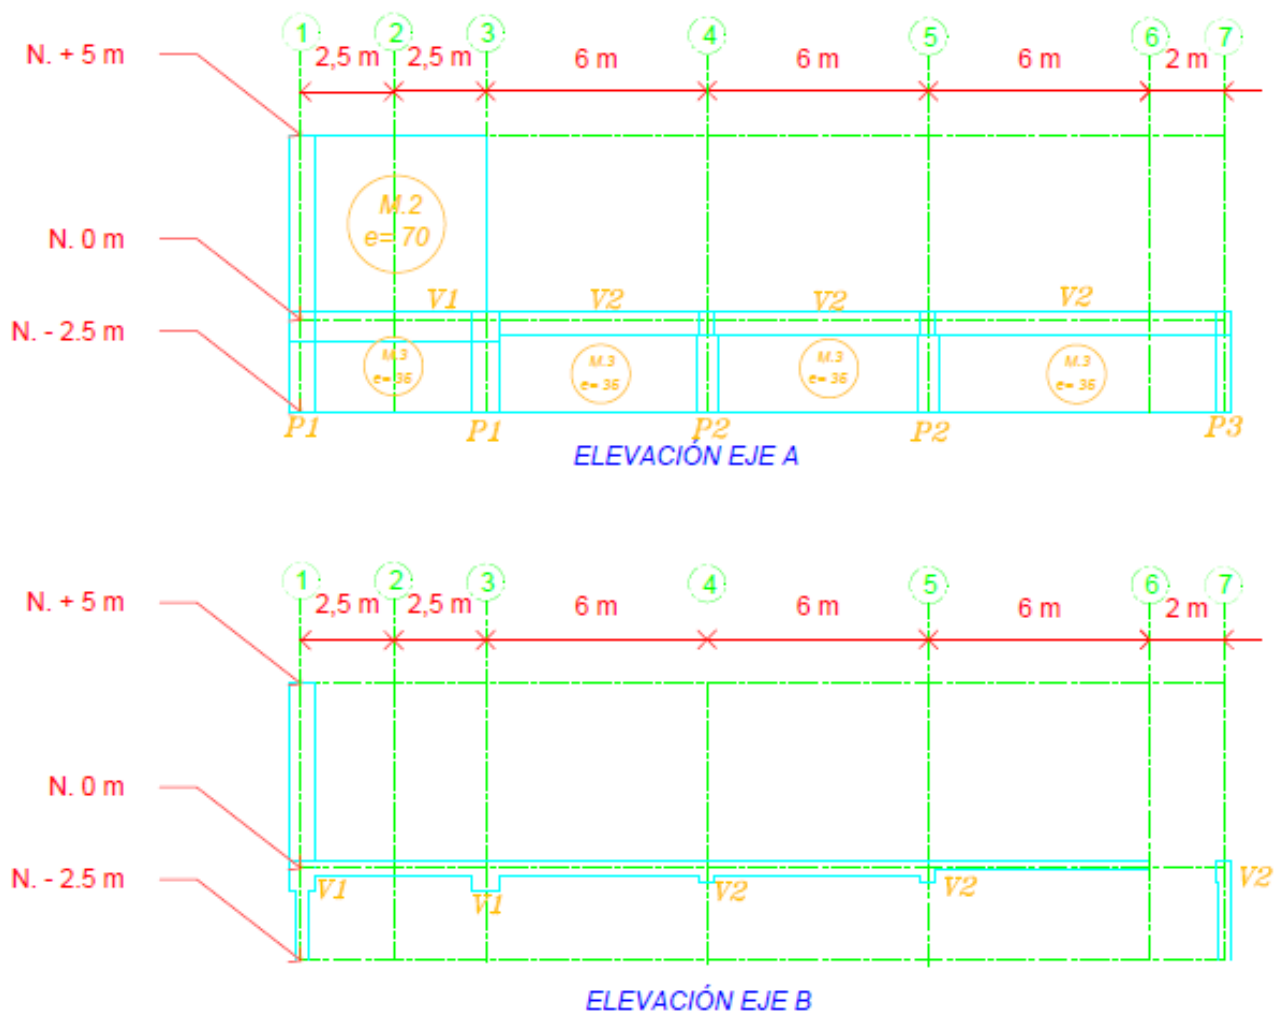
Elevación estructura de hormigón ejes A y B.
